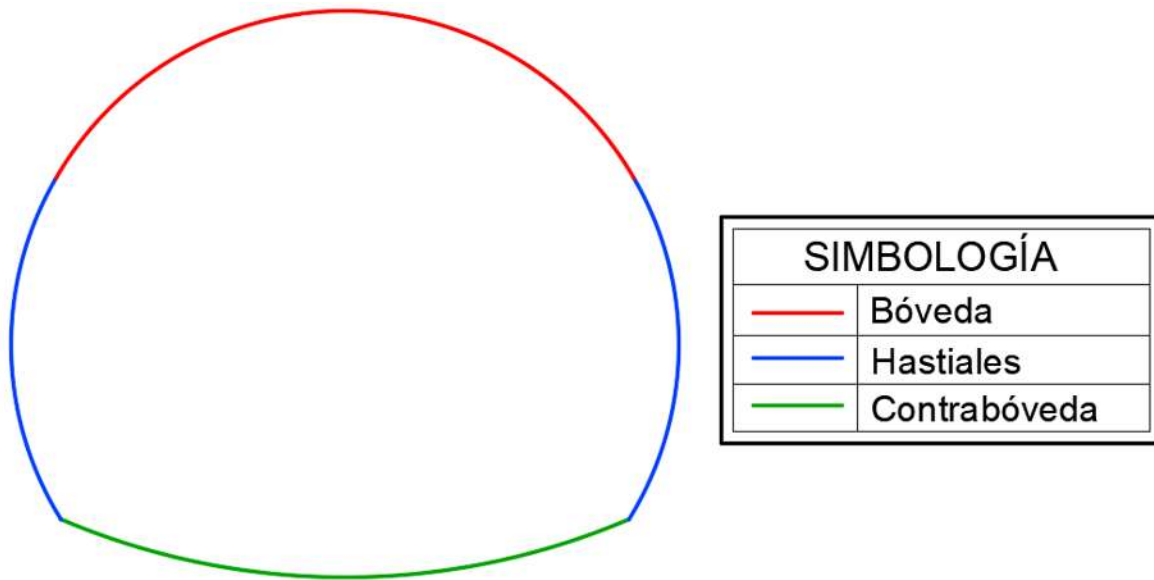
Esquemática de las partes en que se divide la sección transversal en herradura.
